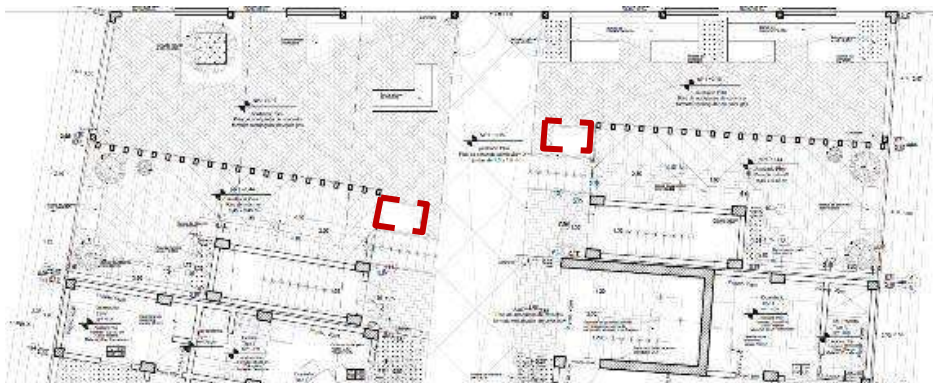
Ubicación de plataformas en la vista en planta de área libre.
